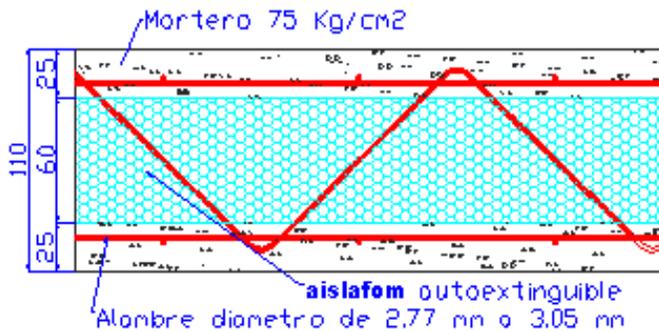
Corte de la estructura de loseta que presenta AISLAPOL S.A.
